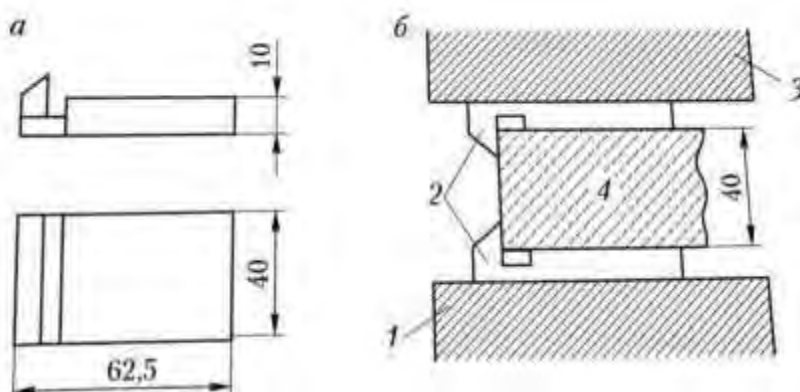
Схема испытания балочки на сжатие: 1 – нижняя плита прессы; 2 – пластинки; 3 – верхняя плита прессы; 4 – образец – половинка балочки
